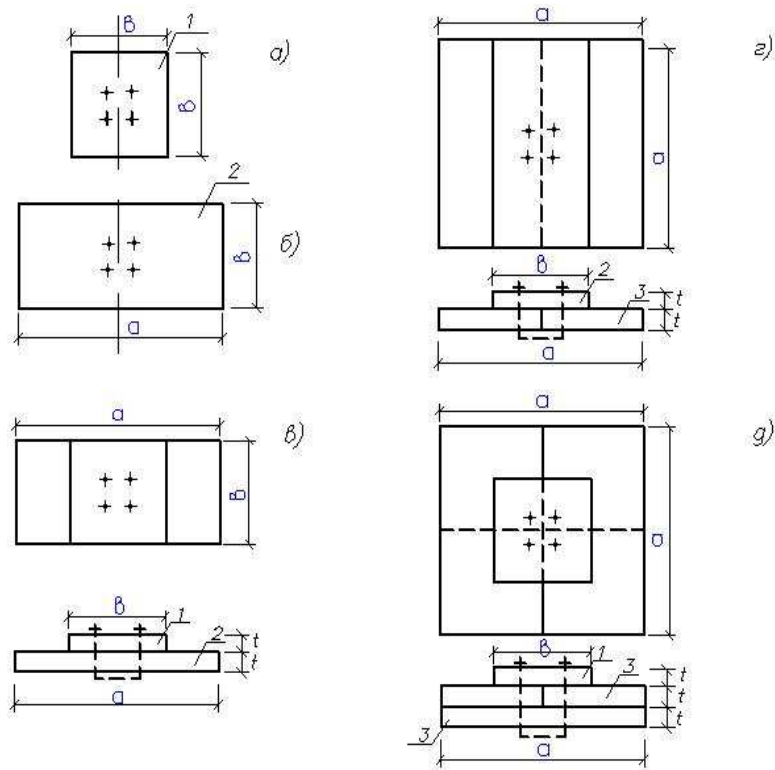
Поверхностные фундаменты, исполненные из сборных железобетонных плит, связанных металлическими хомутами и шпильками:
